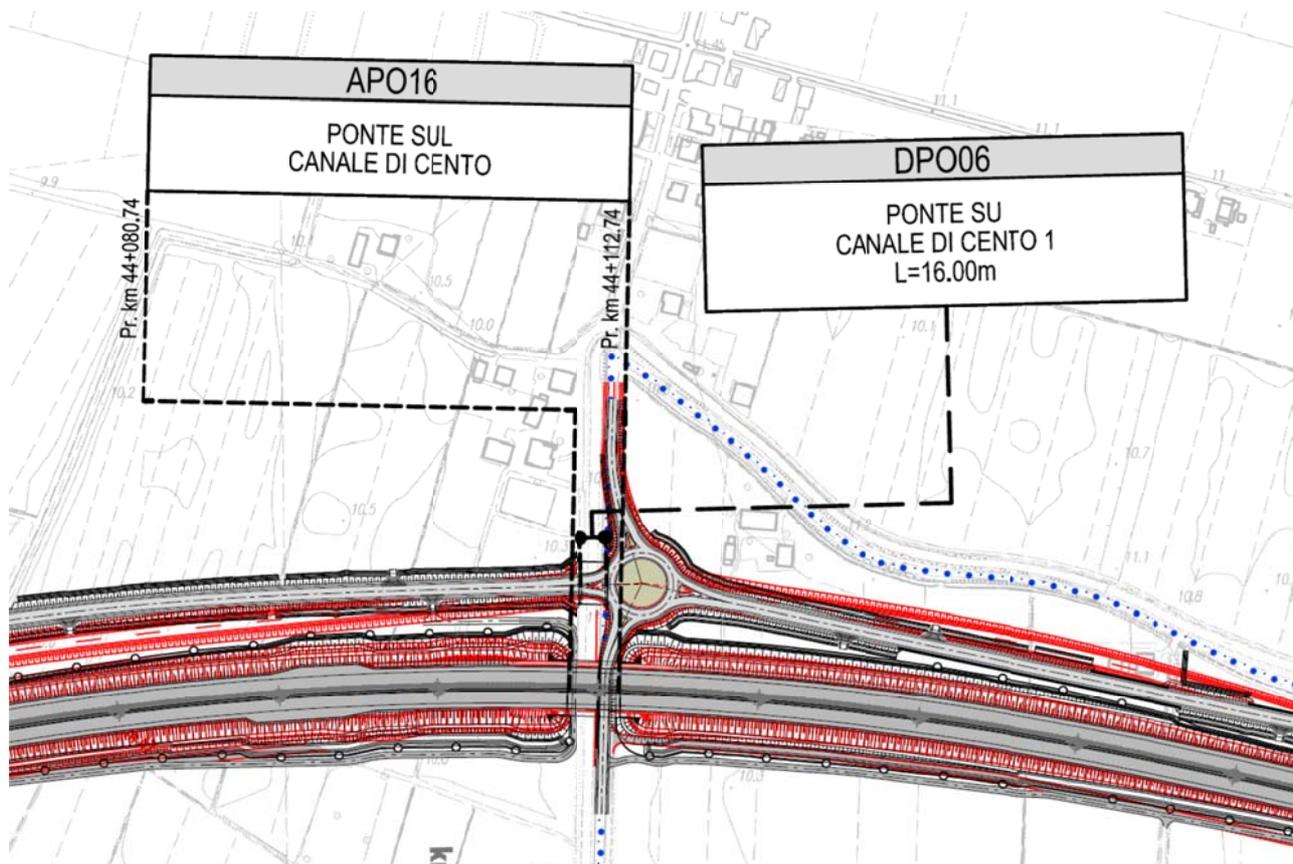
RAFFRONTO PLANIMETRICO PP-PD AREA DI INTERESSE
